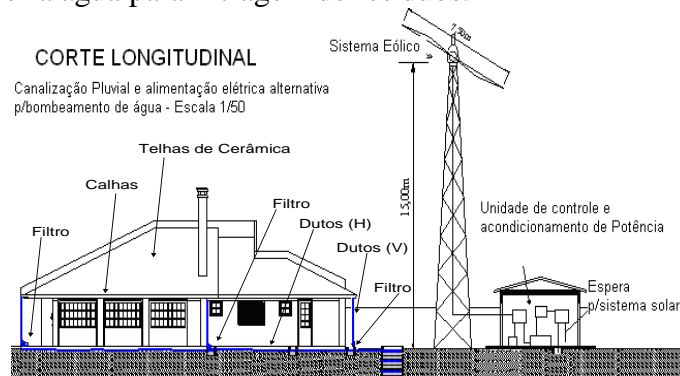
Corte Longitudinal Projeto Piloto – Canalização Pluvial e alimentação eólica alternativa para bombeamento d'água.
